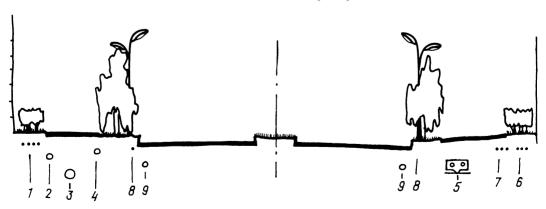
Принципиальная схема прокладки инженерных сетей: 1 — кабельные сети; 2 — водопровод; 3 — канализация; 4 газопровод; 5 — тепловые сети; 6 — слаботочные сети: 7 — силовые кабели; 8 — кабели постоянного тока; 9 — водосток
